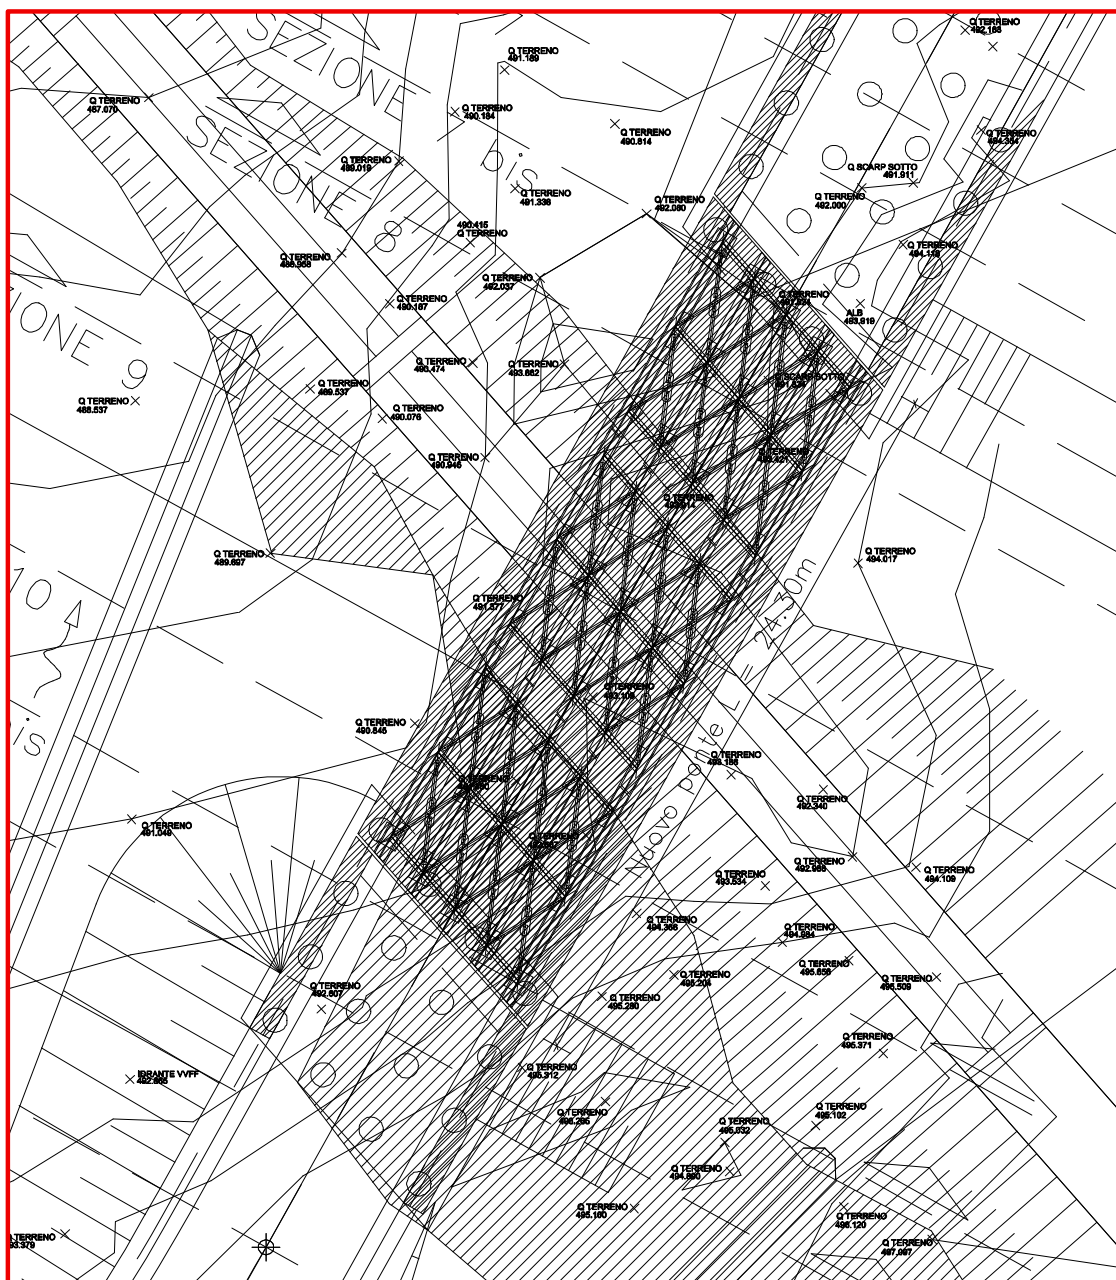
Pianta del ponte con indicazione della struttura di acciaio.
